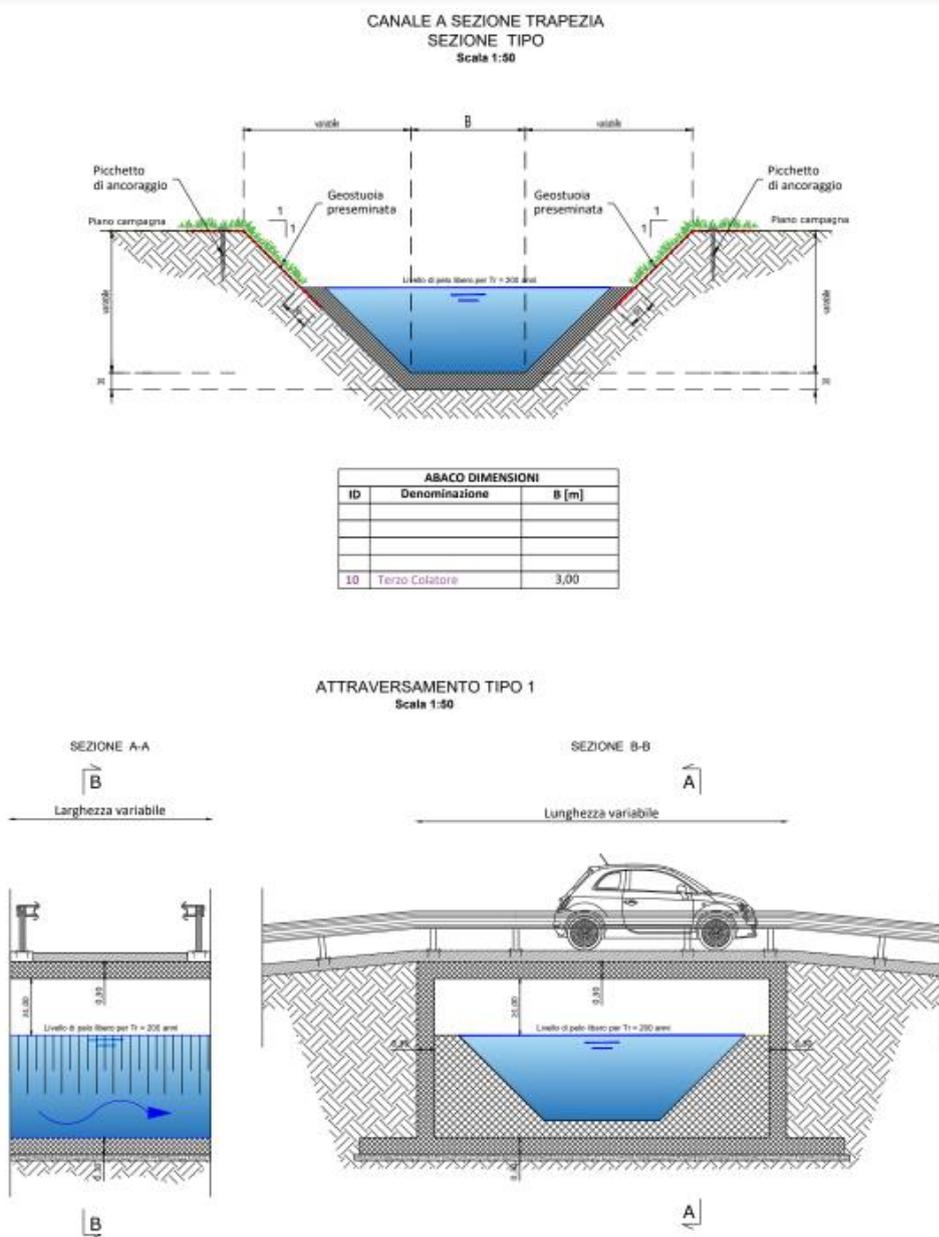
Particolare della sezione di progetto di adeguamento del colatore Bellavista e sezioni di attraversamento stradali
